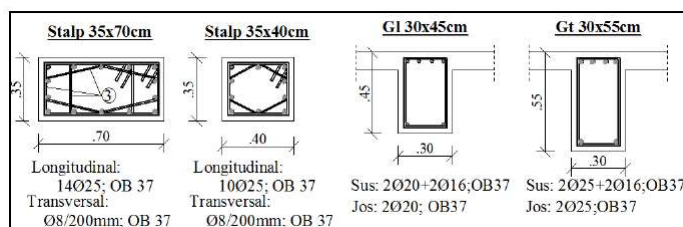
Secțiuni transversale pentru elementele structurale ale clădirii existente
